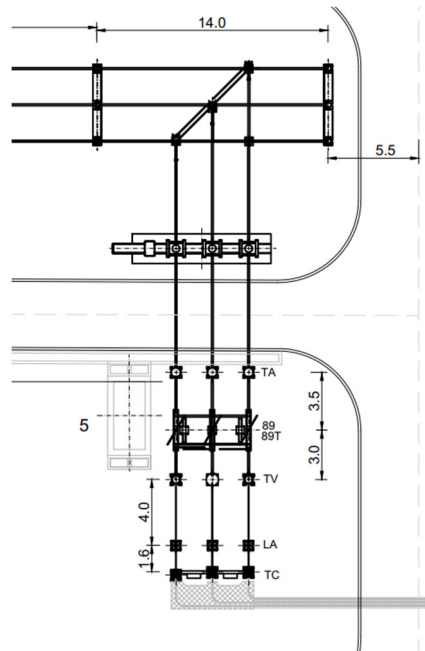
Stazione Nord – planimetria montante linea in cavo estruso a 150 kV
